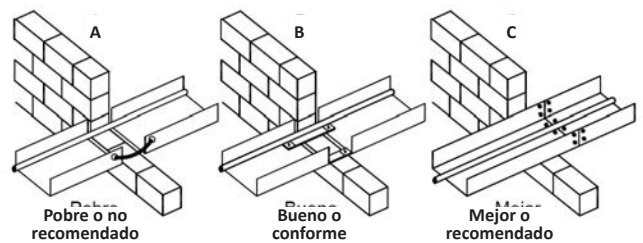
Interrupción de bandejas portacables metálicas por barreras cortafuegos
